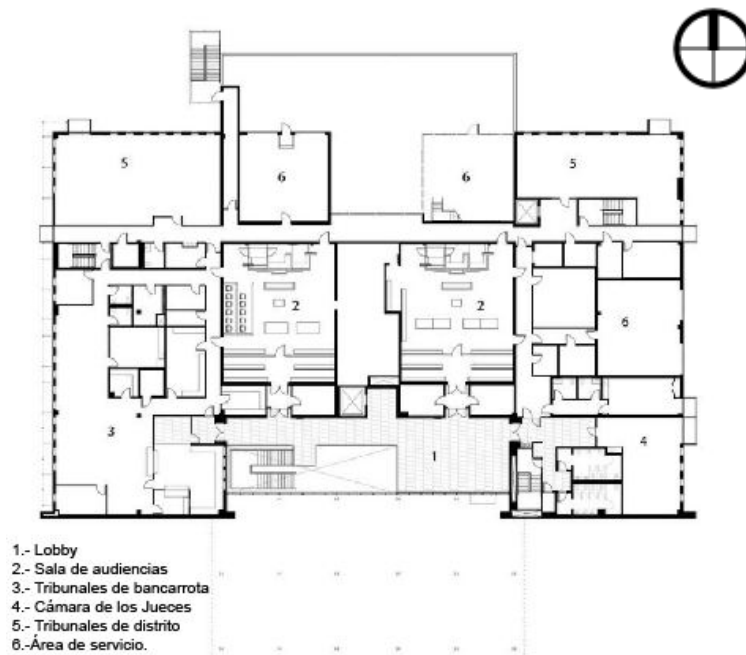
Planta alta del proyecto Palacio de Justicia John M. Roll. Fuente archdaily.mx. Sin escala.
